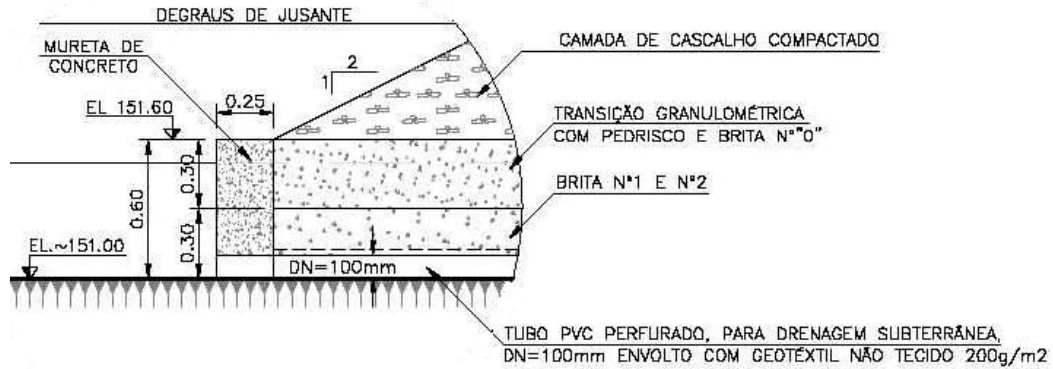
Detalhe da drenagem interna dos reaterros com camadas drenantes e tubo de PVC perfurado com saídas d'água na mureta de concreto
